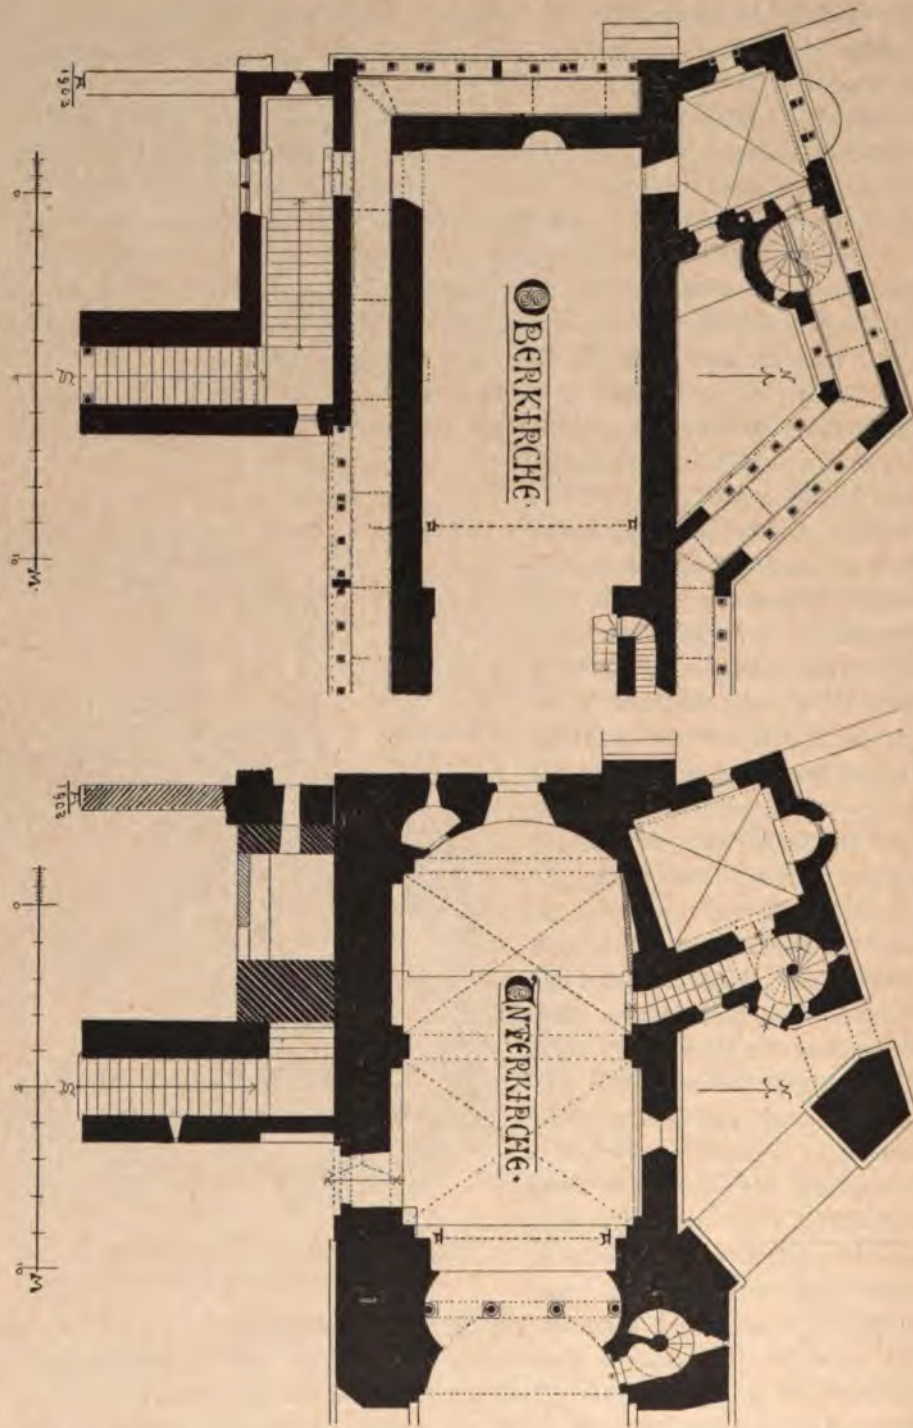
Schwarz-Rheindorf, Stiffrkirche. Grundrisse des neuen Sakristieanbaues.
